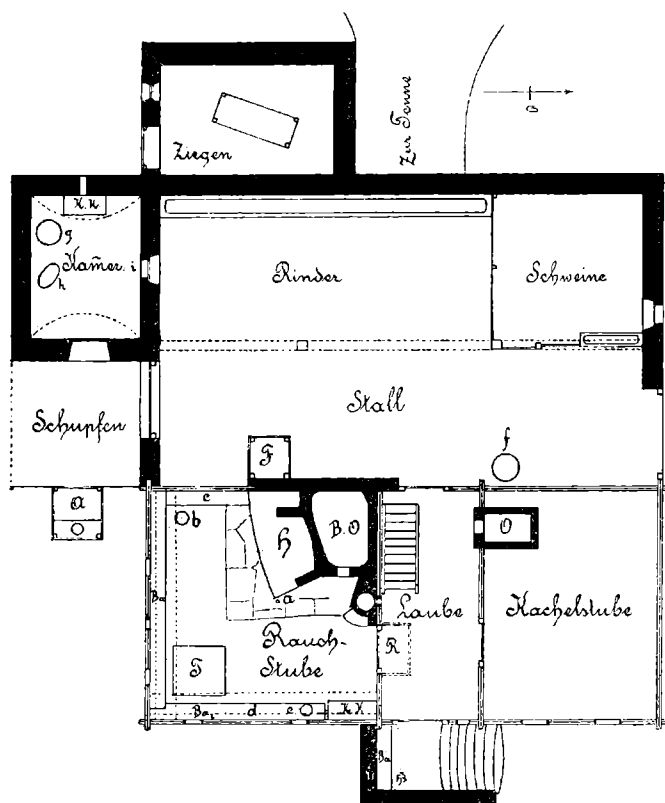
Grundriss des Mauerbauer-Hauses.
